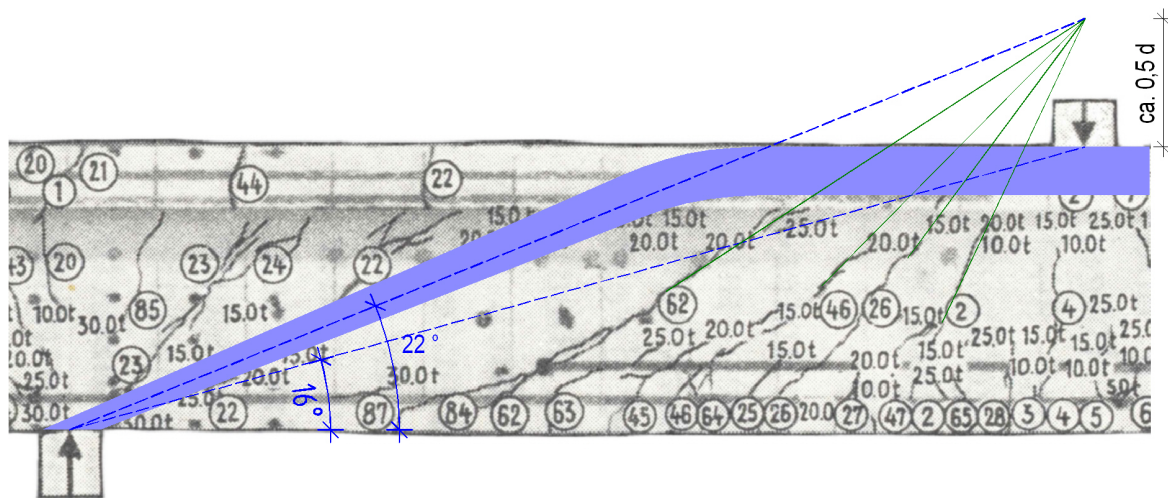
Gemessene Druckstrebenrichtung und Rissrichtungen im Balken HS 4 aus [2.7]
